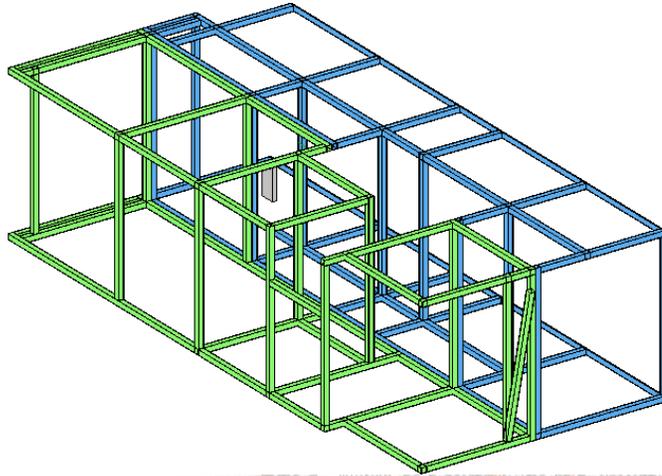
Reforzamiento de estructura módulos 6 y 7 de planta 1, zona escalera-ascensor. Elaboración propia.
